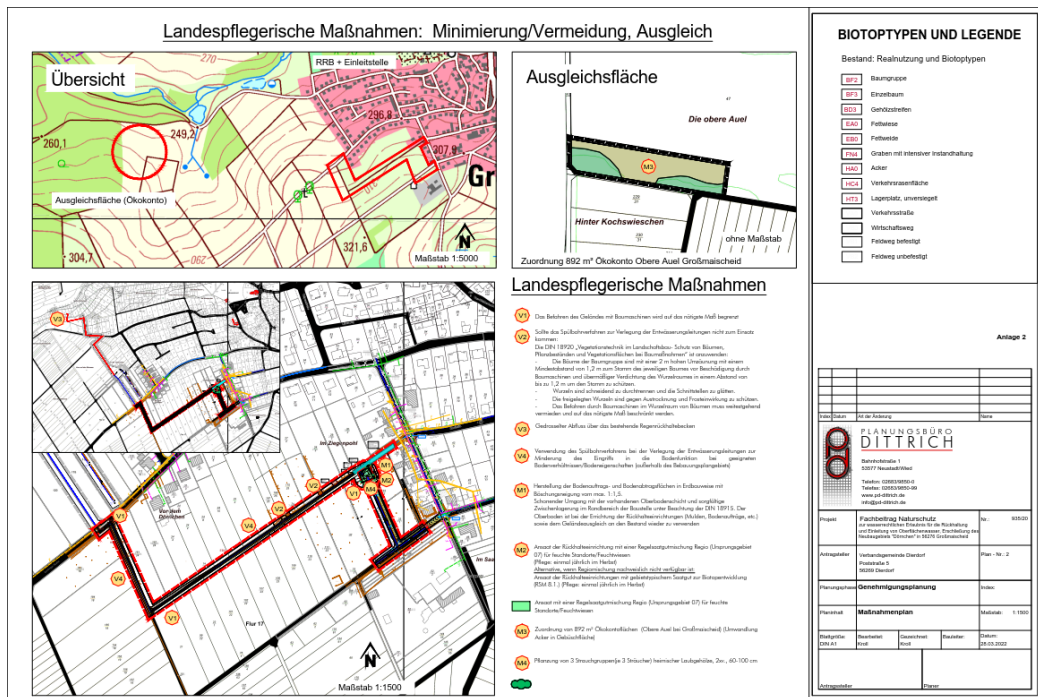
Maßnahmenplan aus dem Fachbeitrag Naturschutz
